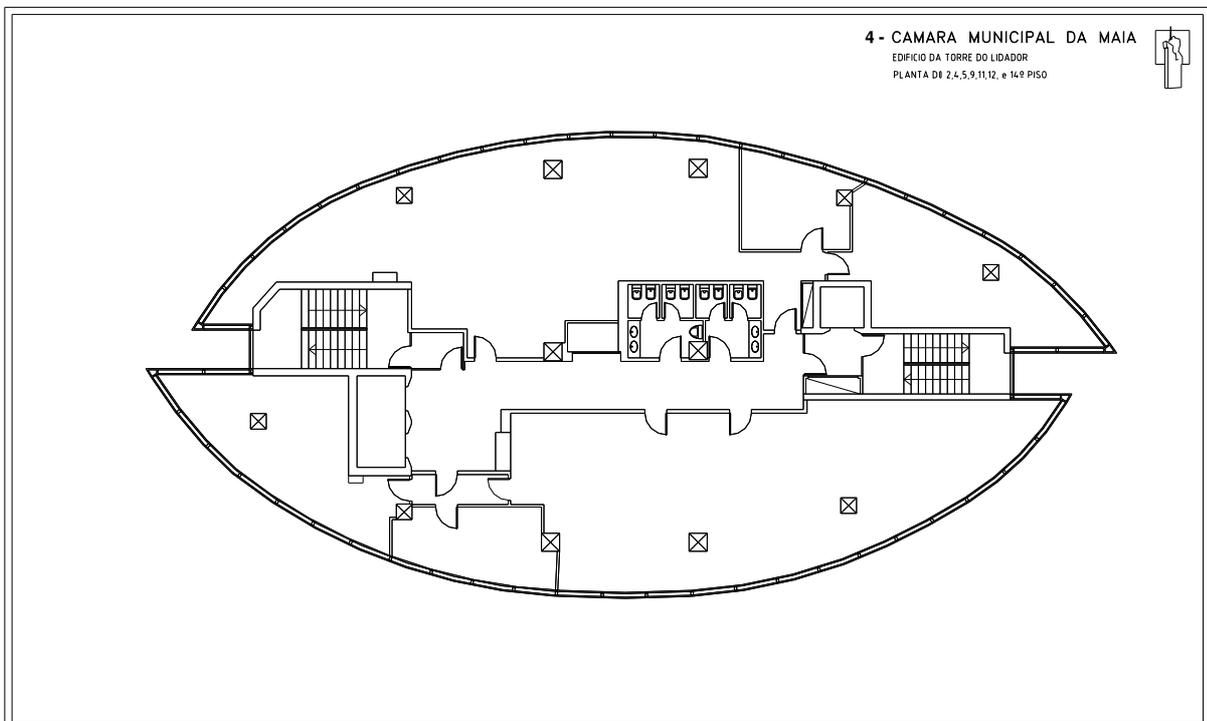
Planta do piso 2 ao 18 (excepto piso7).
